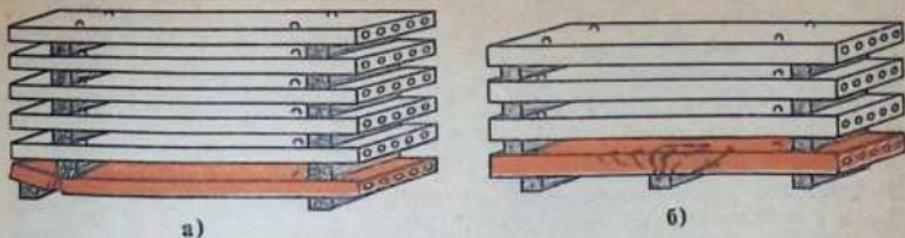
Разрушение железобетонных плит при неправильном складировании:
